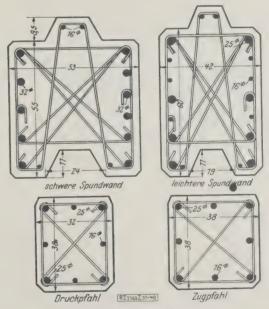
bis 40 Querschnitt und Bewehrung der Beton-Spundwandbohlen.
